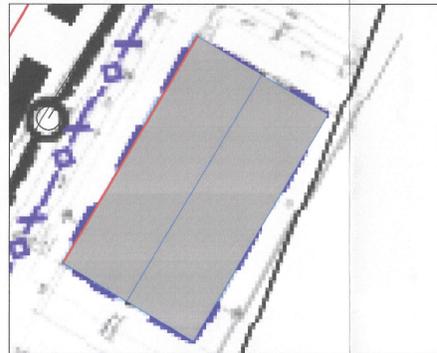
Darstellung der Fassaden, an denen keine Immissionsorte nach 18. BImSchV entstehen dürfen.
